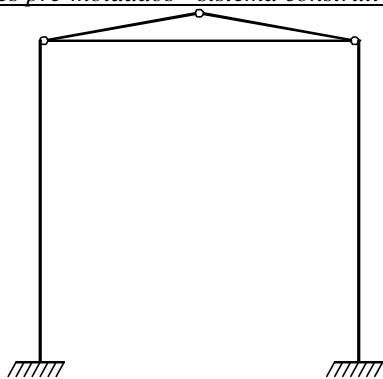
Pilar engastado na fundação e elementos de cobertura articulados entre si e nos pilares (apud EL DEBS, 1996).
